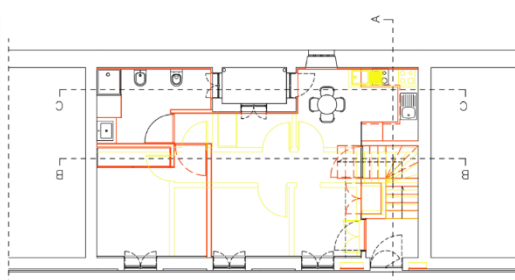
Planta Piso Térreo - Demolição/Construção
